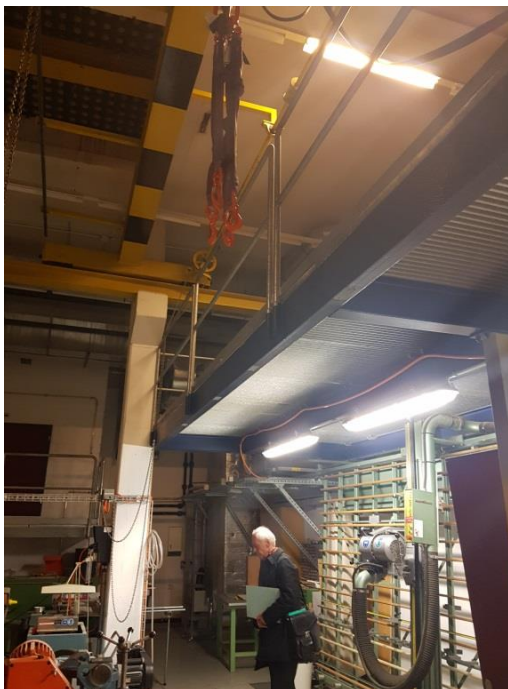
Stahlkonstruktion, Technik Raum Nr. D68.3
